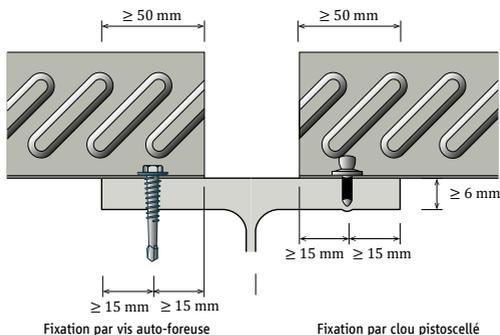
Exemples de fixation d'un bac collaborant par vis auto-foreuse ou par clouage
